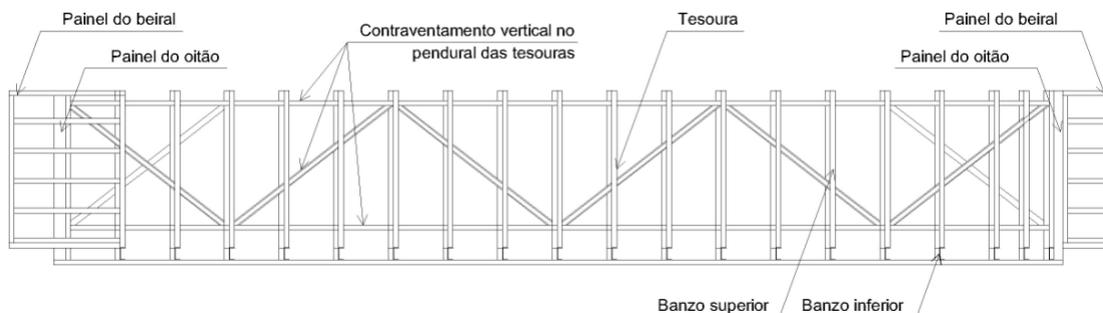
Vista lateral de estrutura de telhado mostrando o contraventamento em "X" do sistema de tesouras.
